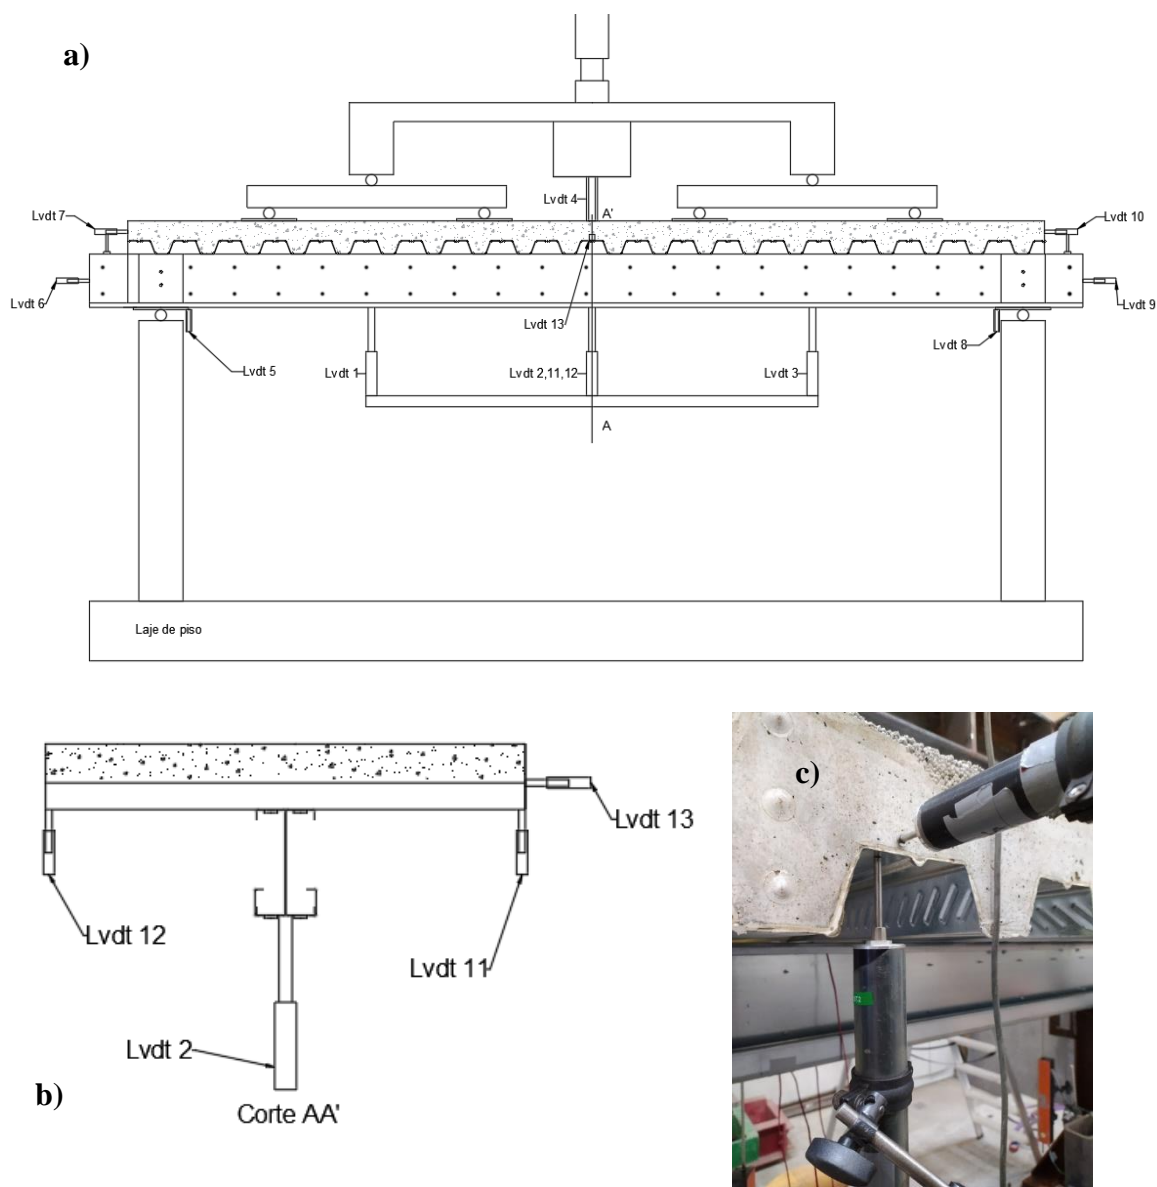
a) Esquema da posição dos LVDT's, b) Vista transversal da secção de meio vão dos LVDT's, c) Pormenor dos LVDT's 11 e 13
